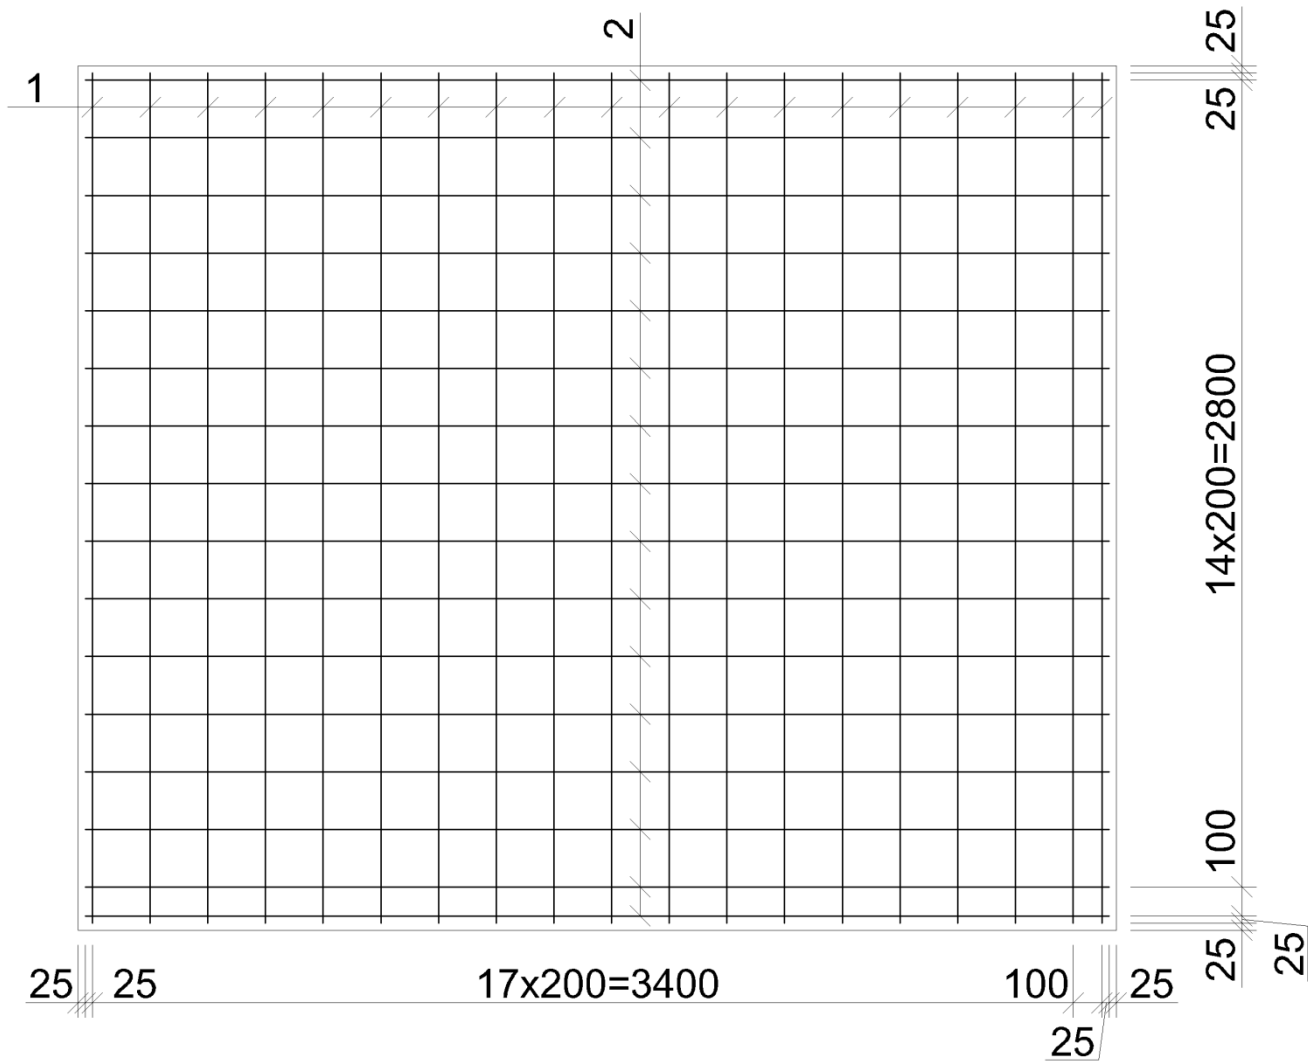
Арматурная сетка С1 в подошве фундамента
